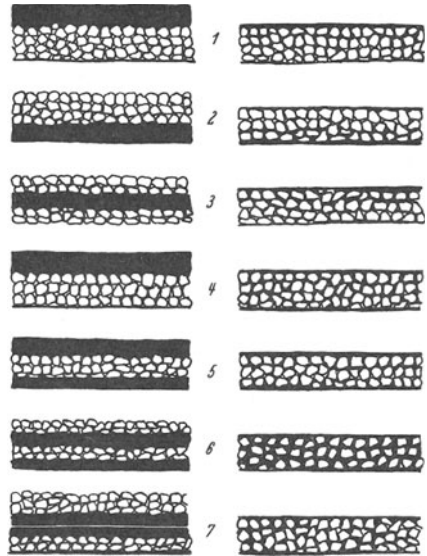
Verschiedene Ausführung der Mörtelschotterdecken. Reihenfolge der Arbeiten: Aufbringen des: 1 Steinschlages — Mörtel, trocken oder naß — Walzen, 2 trockener Mörtel — Steinschlag — Walzen mit Wässern, 3 Steinschlag — leichtes Walzen — Mörtel trocken oder plastisch — Walzen mit Wässern bei trockenem Mörtel, 4 Steinschlag — Mörtel trocken — Eineggen des Trockenmörtels — Walzen mit Wässern, 5 Dünnes Mörtelbett naß — Steinschlag — Mörtellage — Walzen, 6 Mörtel — Steinschlag — Leichtes Walzen, 7 Mörtel — Steinschlag — Walzen, 7 Steinschlag — Mörtel — Eineggen — Walzen — Mörtel — Steinschlag — Walzen.
